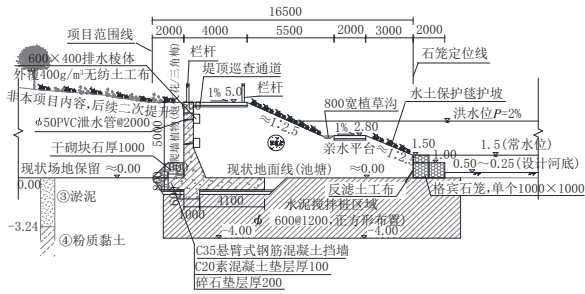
B 型护岸挡墙衔接式断面示意图(单位:mm)
